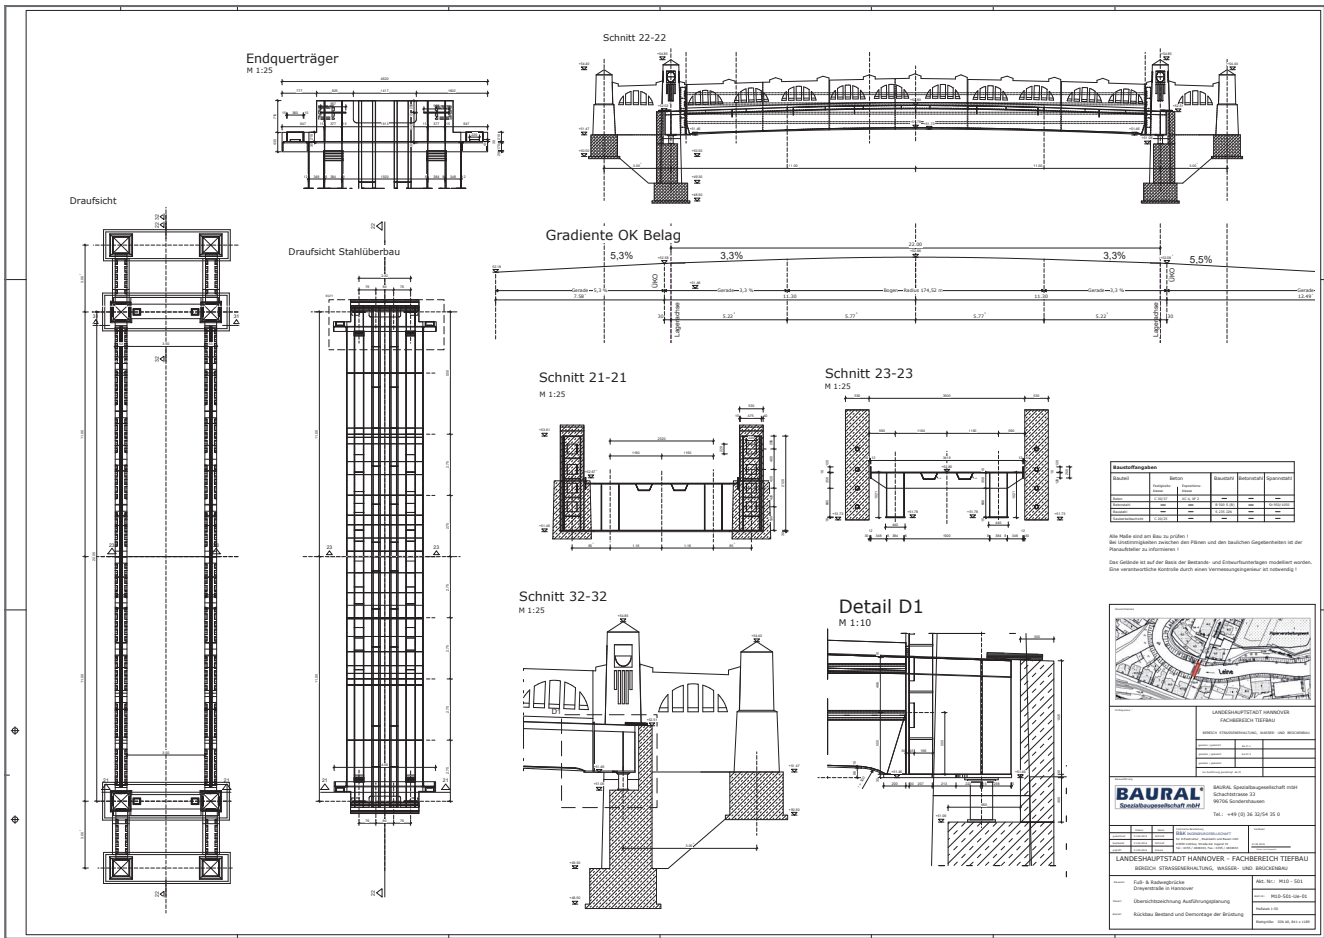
Plan Überbau, Zeichnungen abgeleitet aus dem 3D-Modell in ViCADO
